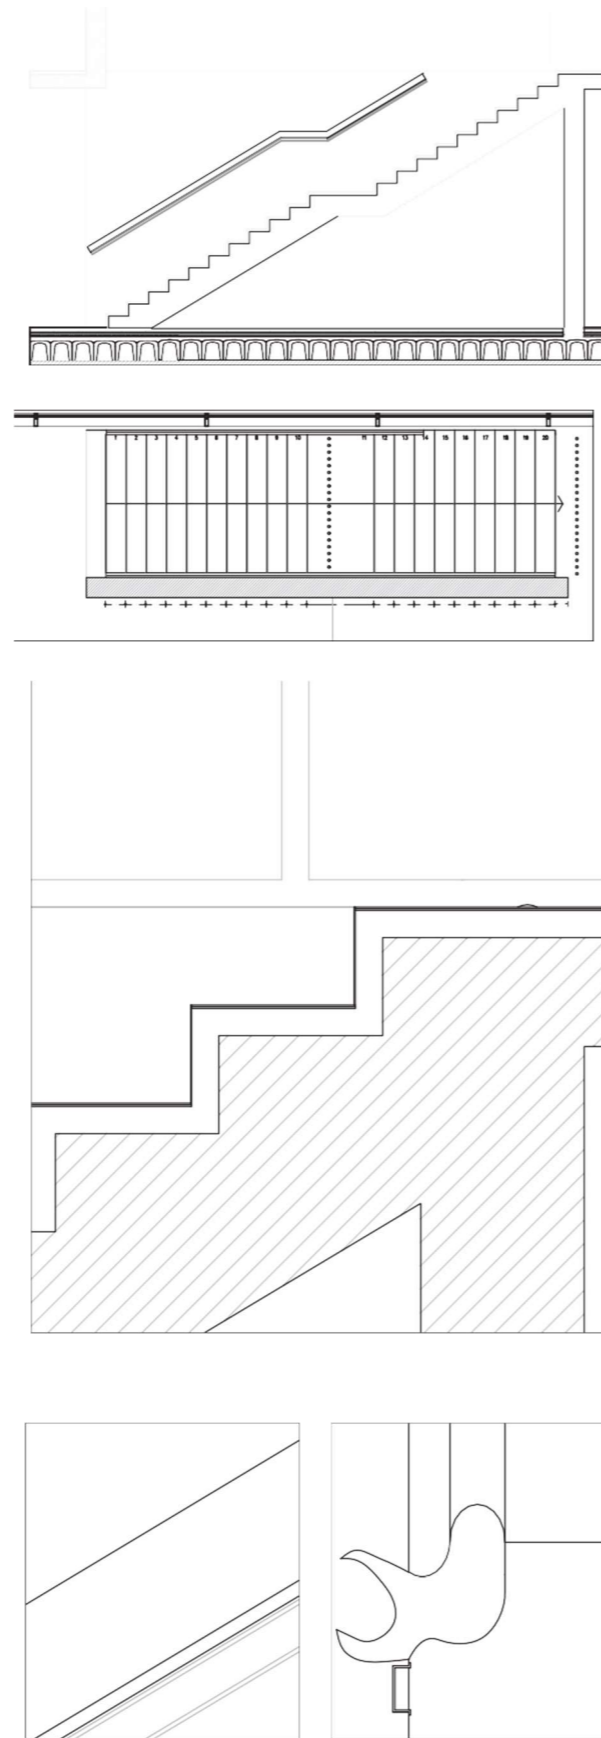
Desenho do autor, Corte construtivo de uma escada
